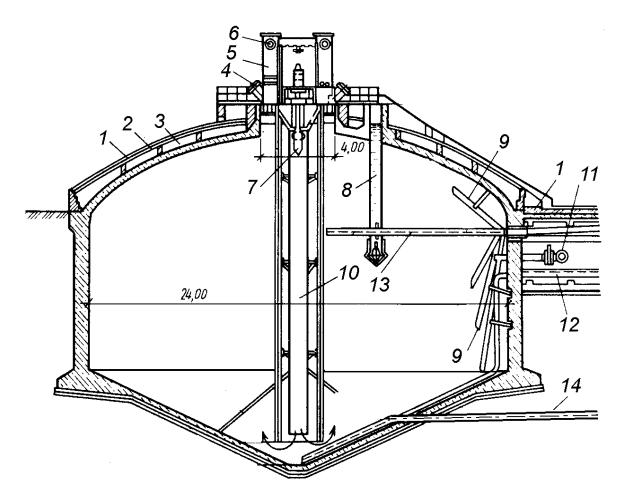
Схема метантенка Ново-Курьяновской станции аэрации: 1—битумная обмазка; 2 — клинкерная кладка; 3 — теплоизоляция; 4—контрольный люк; 5— газосборная горловина; 6— труба для отвода газа; 7 — механический смеситель; 8 —переливная труба; 9—выпуск осадка с разных уровней; 10— направляющая труба для циркуляции иловой смеси; 11 — трубопровод для подачи пара на обогрев; 12 — труба выпуска сброженного осадка; 13 — труба подачи осадка; 14 — труба для опорожнения метантенка.
